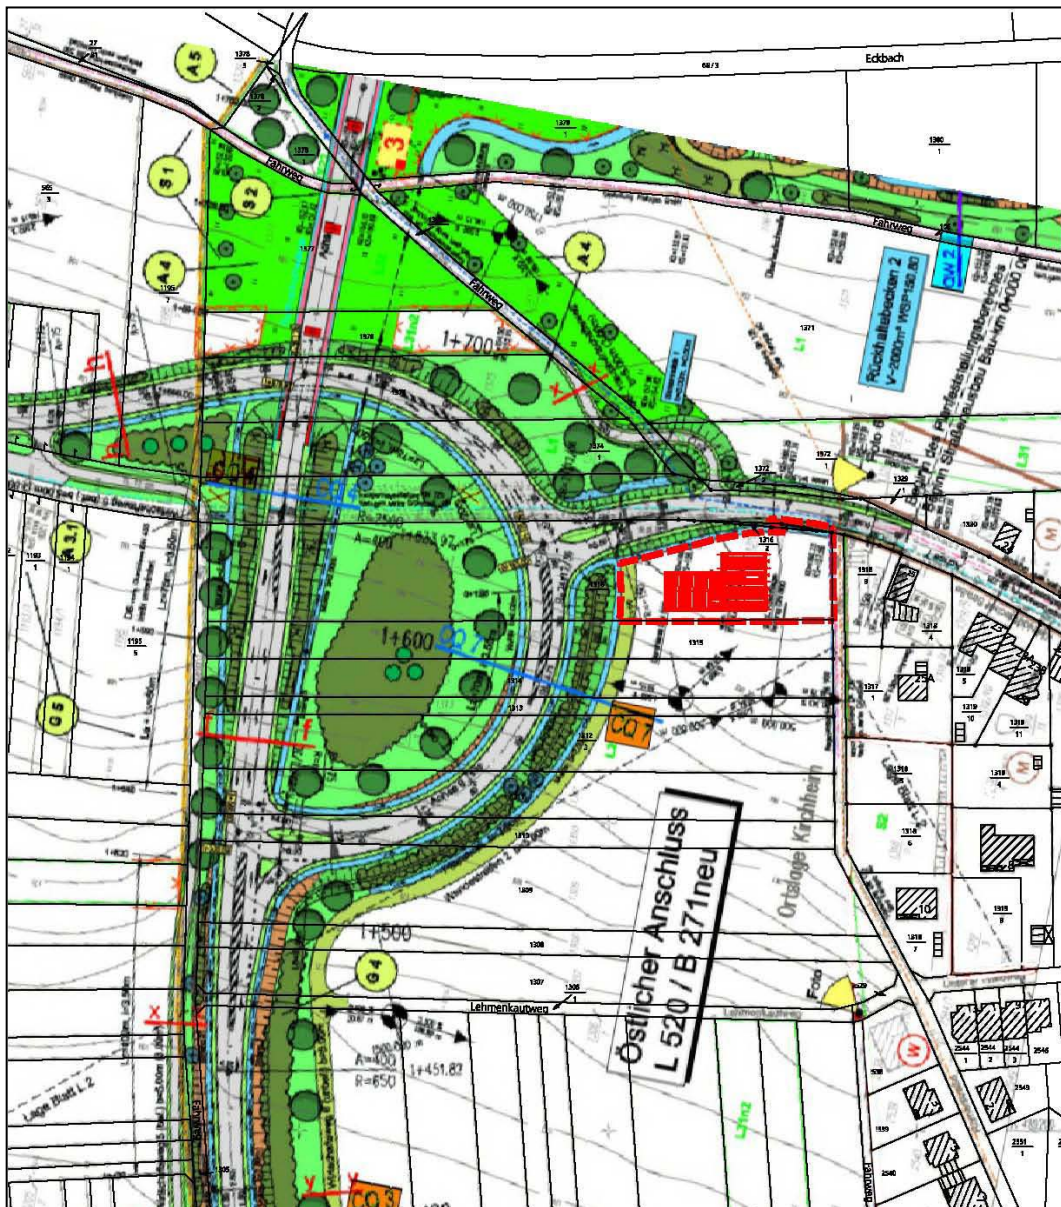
Plandarstellung zur Planfeststellung der B 271n (Entwurf) mit Grundstück des geplanten Feuerwehrhauses.
